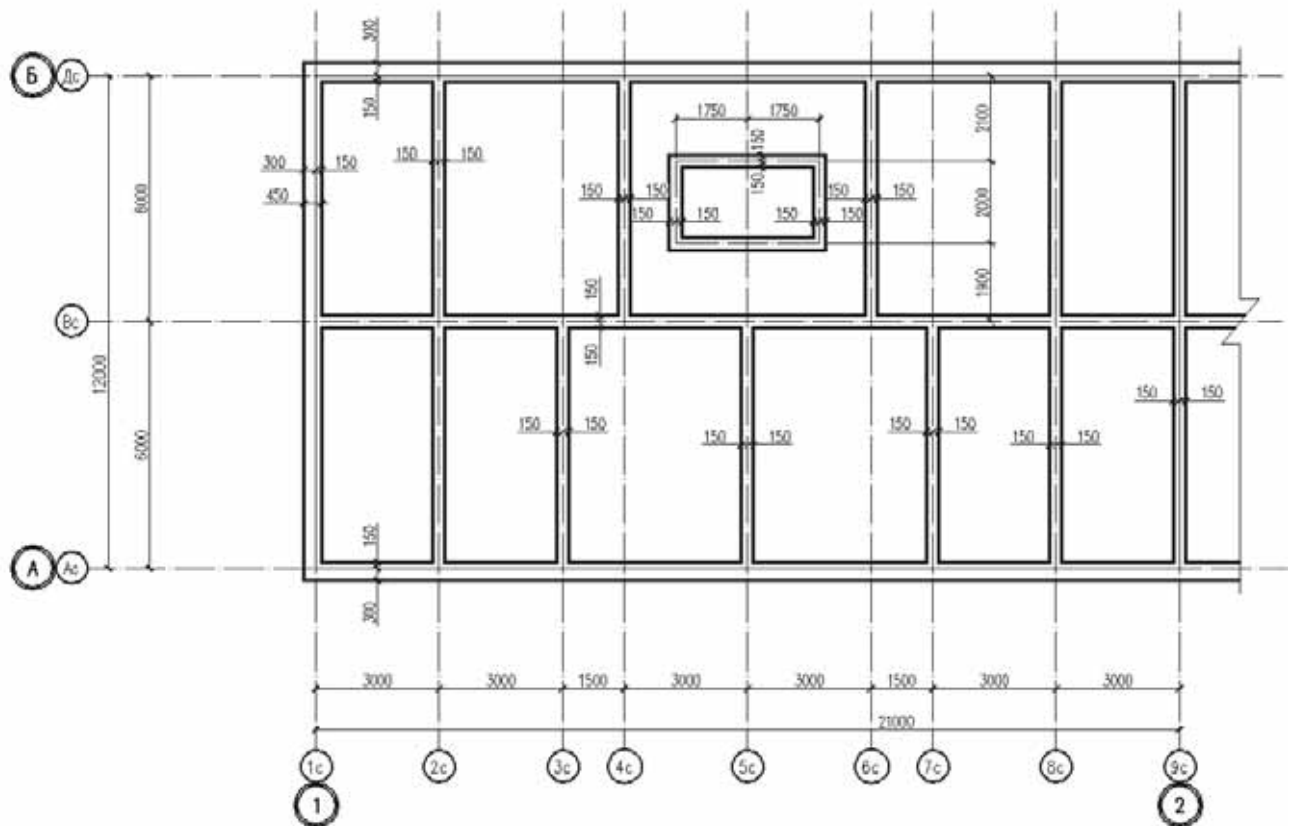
План расположения фундаментов в осях 1-2.
